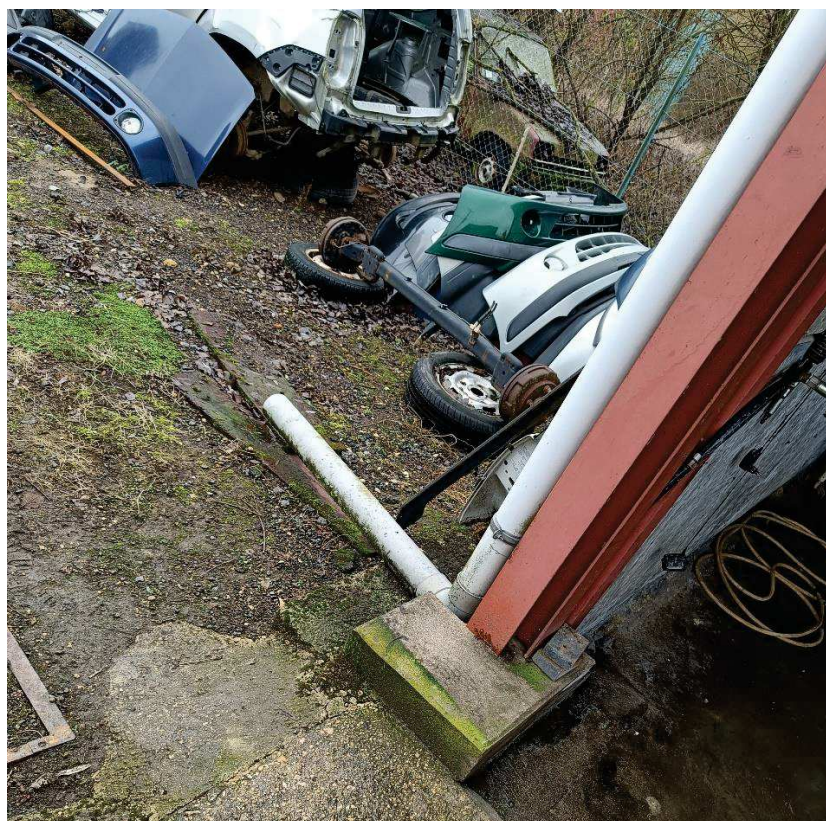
Déversement des eaux pluviales de toiture sur le terrain
